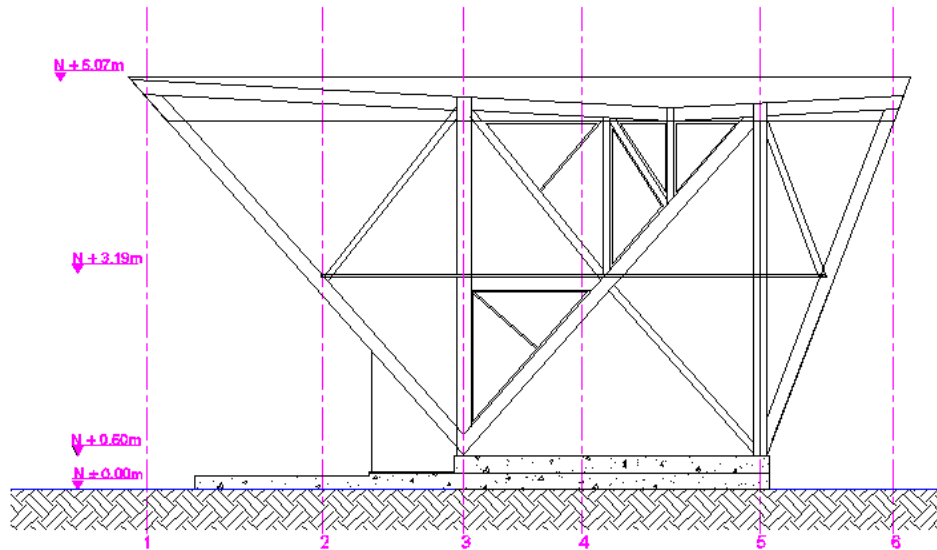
Corte arquitectónico de vivienda en guadua laminada
